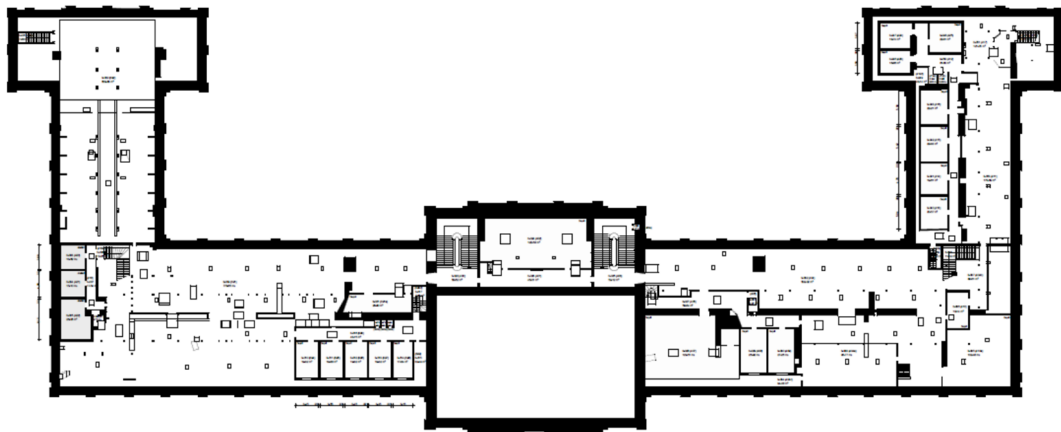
Grundriss Dachgeschoss Corp de Logis Süd, Corp de Logis Nord, Heinrichsflügel und Theaterflügel
